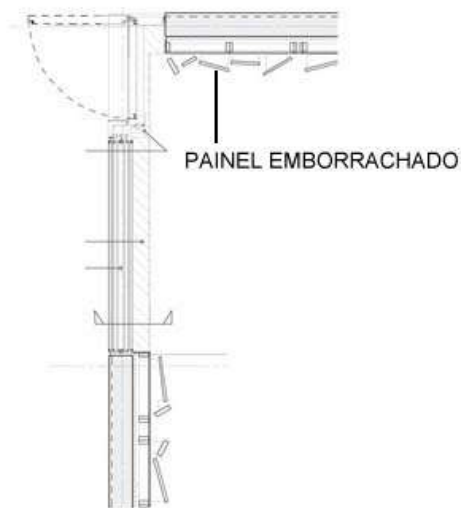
Esquema em planta de isolamento acústico. Fonte: ArchDaily, editado pela autora.
